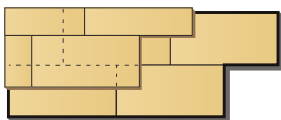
Укладка плит с перекрытием швов при двухслойном утеплении
